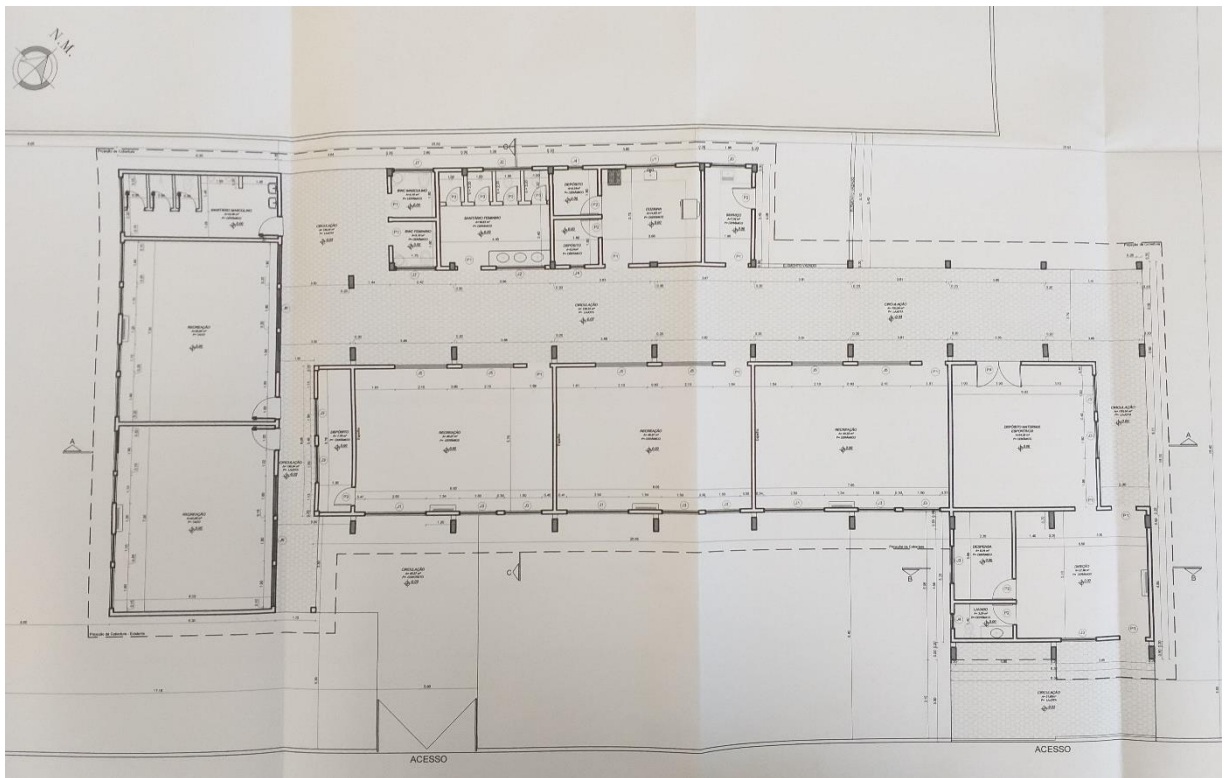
Planta baixa proposta. (Fonte: PMC)
